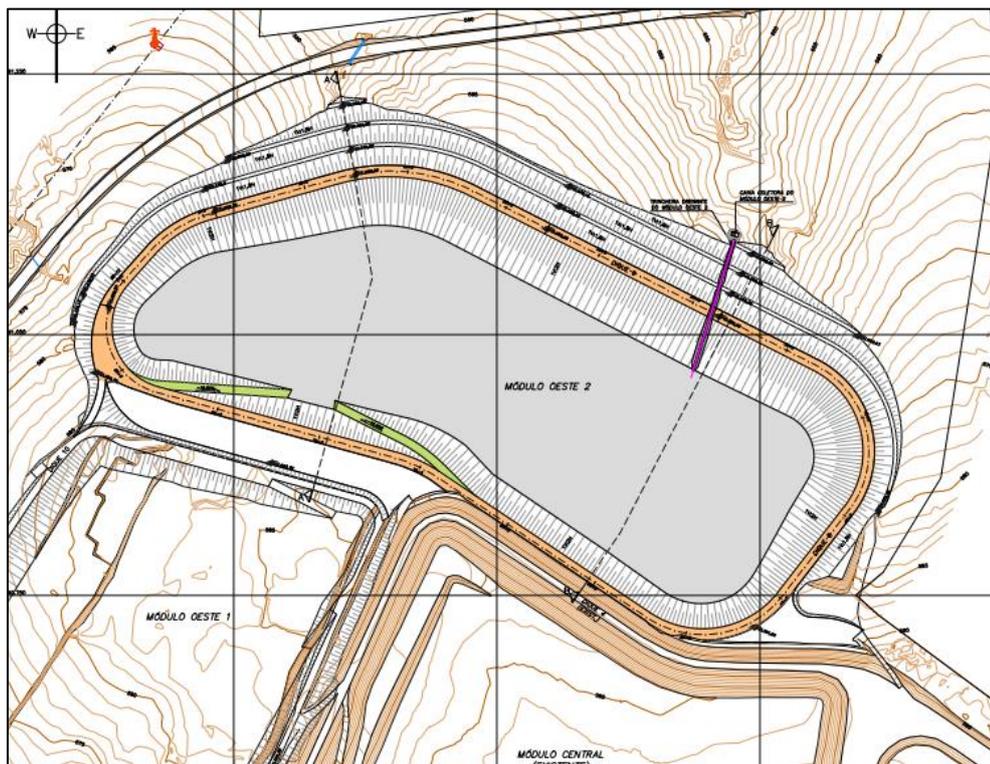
Esquema da estrutura (Fonte: CM61DE01-R0 - Módulo Oeste 2 – Planta).
